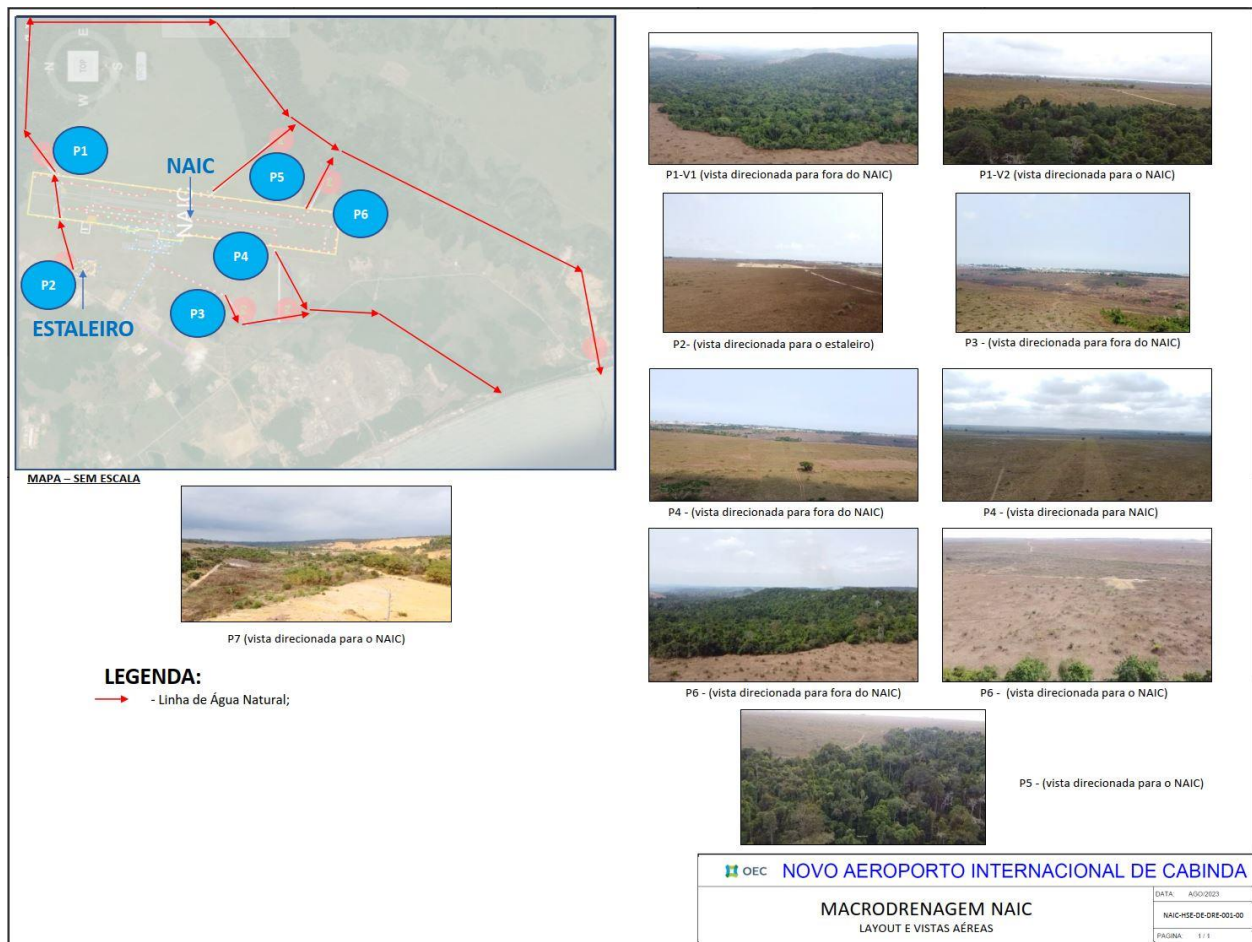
Sistema de drenagem do NAIC para a fase de construção.
